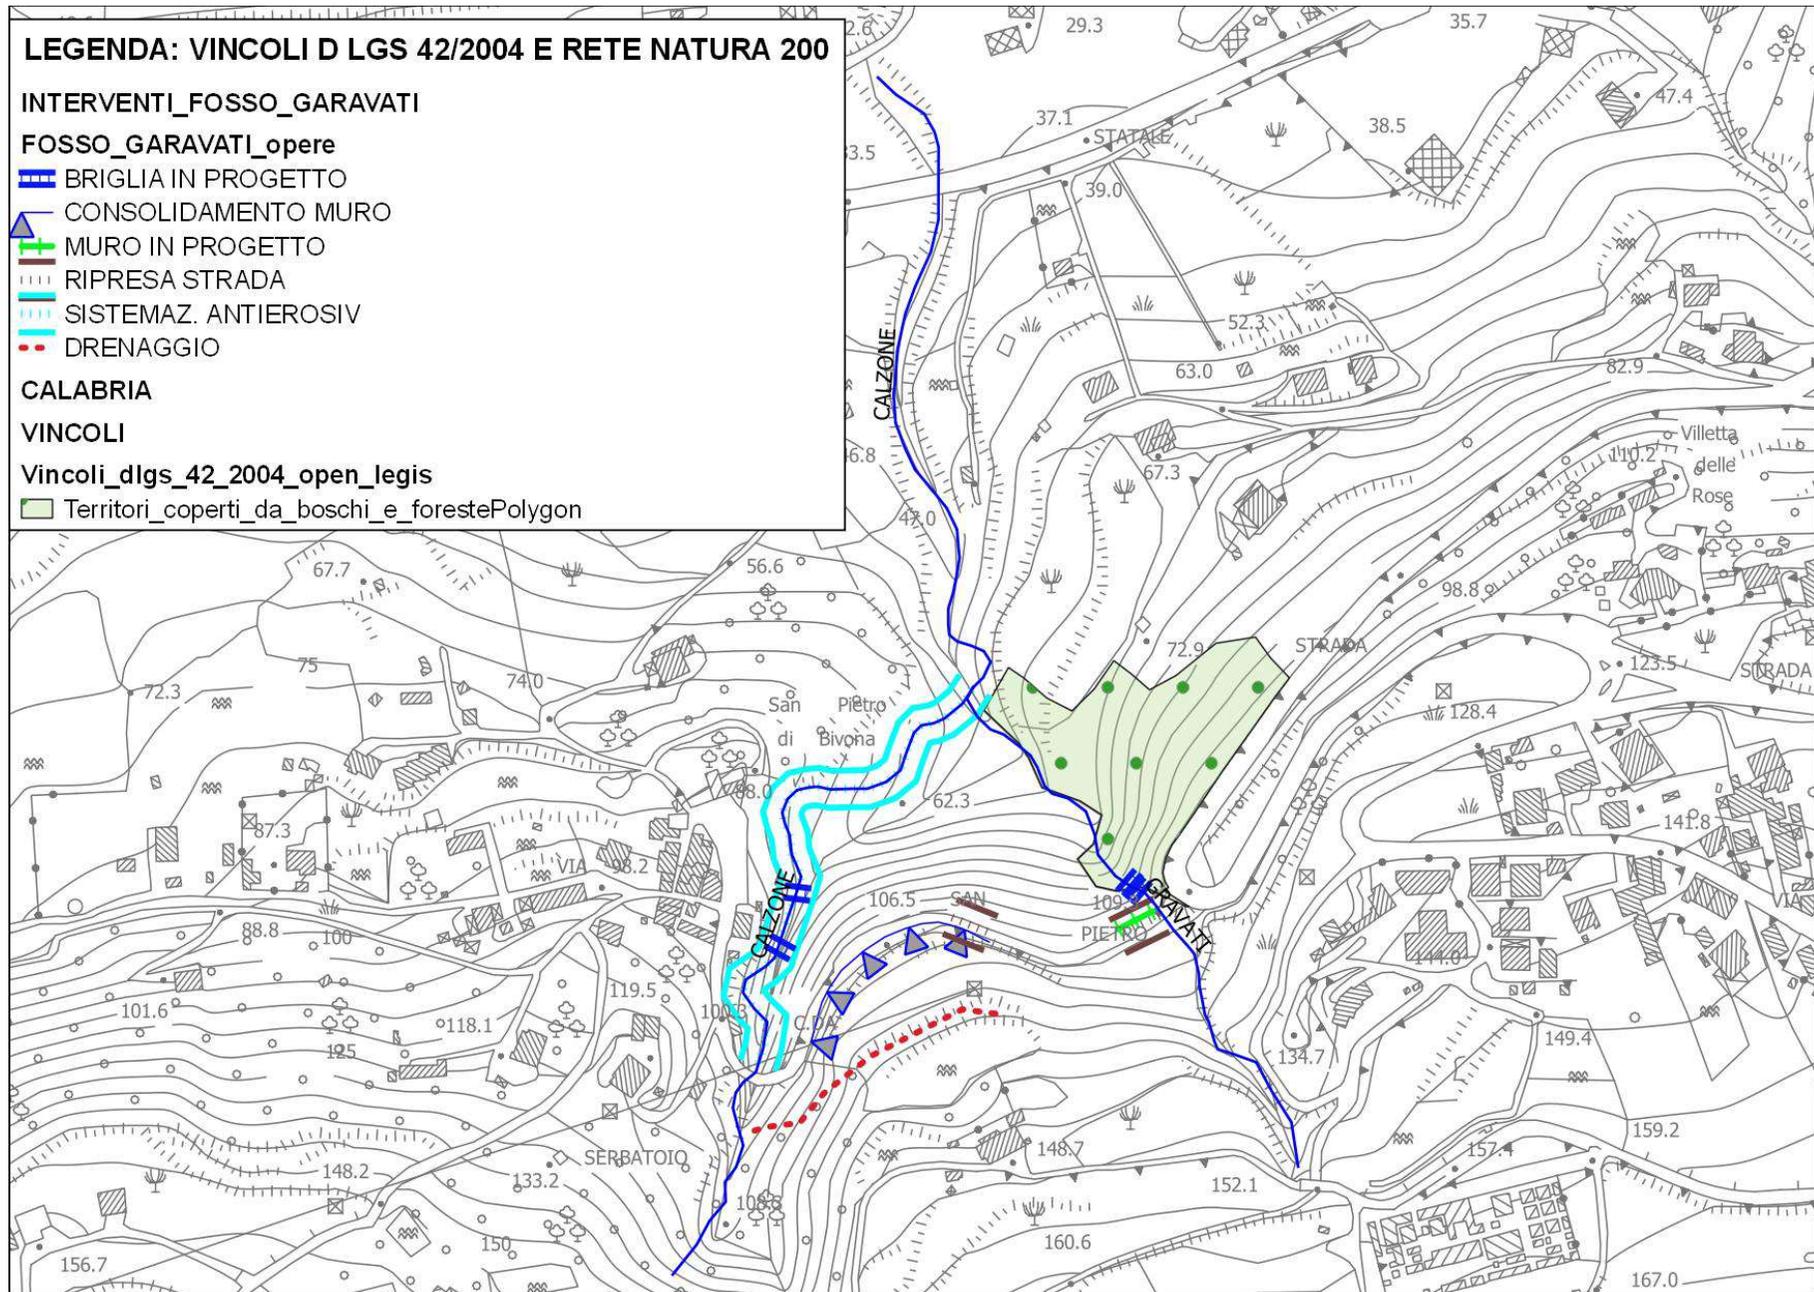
Planimetria con individuazione vincoli Rete Natura 2000 e D. Lgs 42/2004
